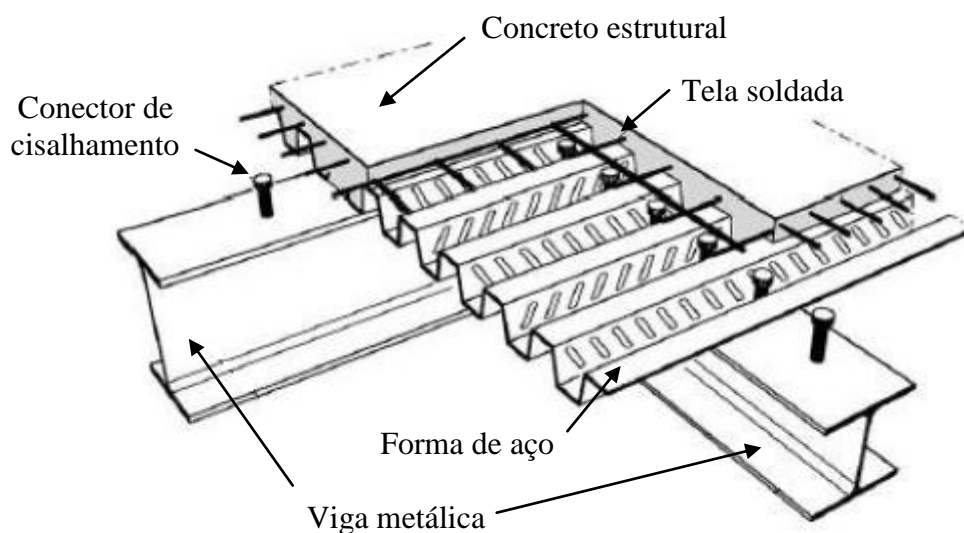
Exemplo do sistema de lajes mistas
